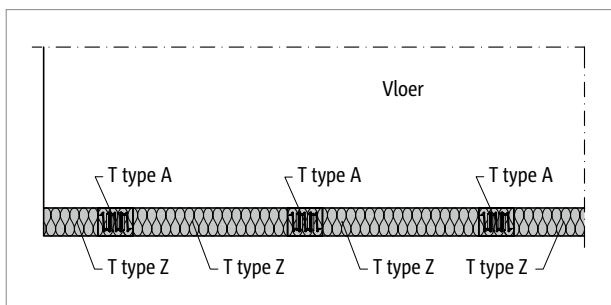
Schöck Isokorb® T type A horizontale toepassing: Boven aanzicht borstwering voorgeplaatst
